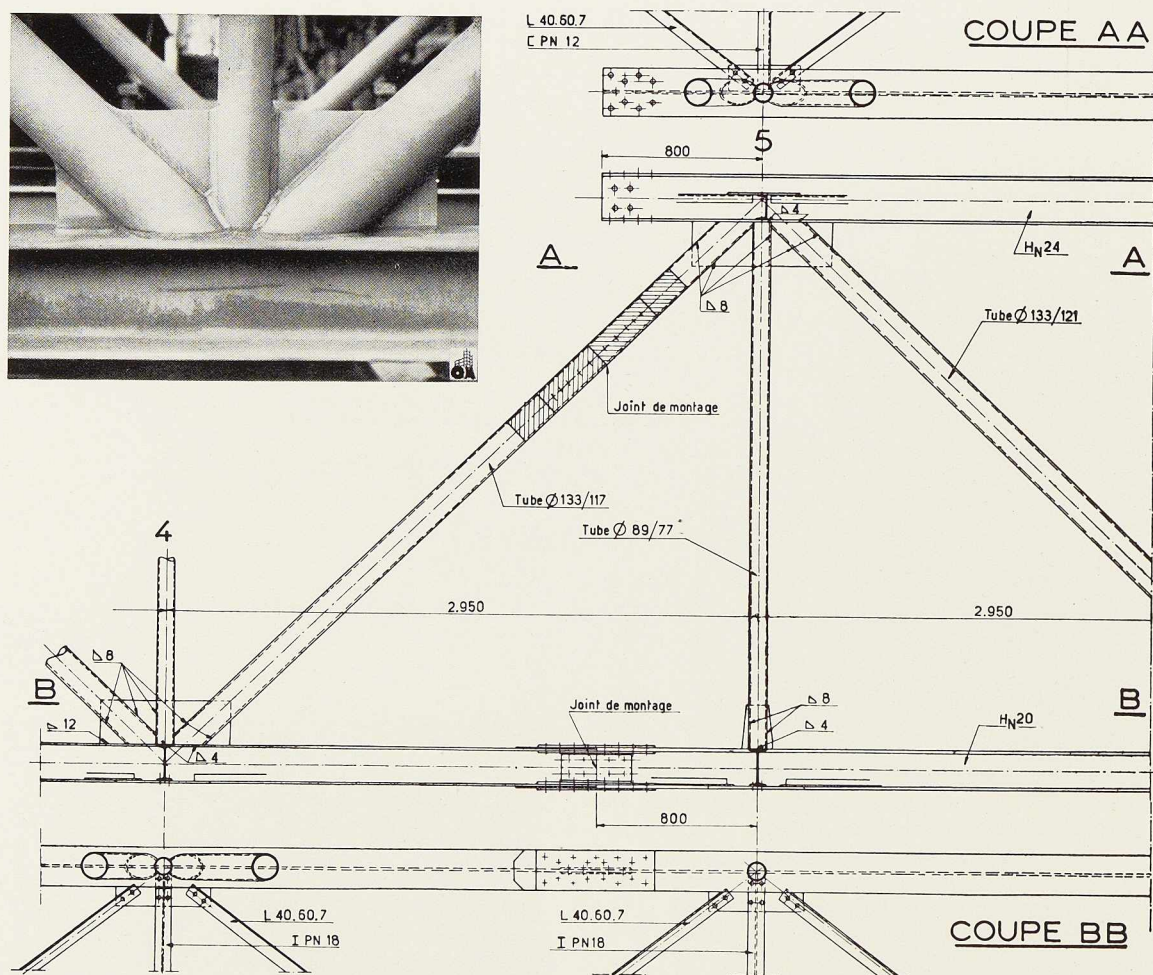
Détails constructifs de la poutre principale se rapportant au panneau 4-5 (voir fig. 377).
